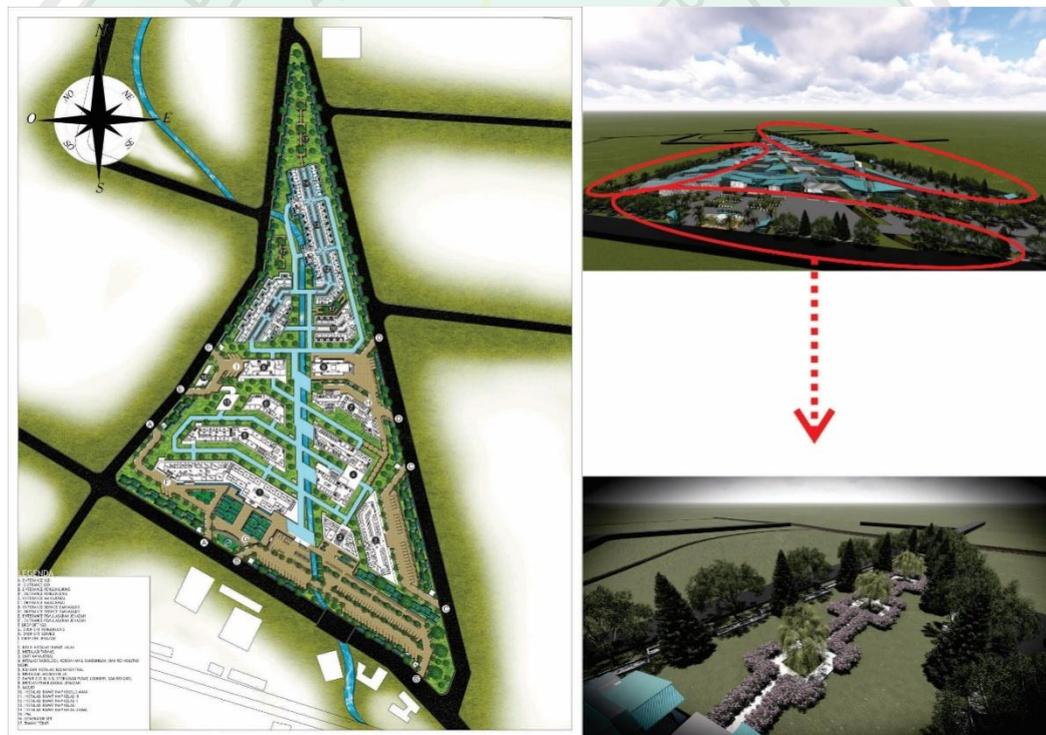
layout plan (sumber: hasil perancangan. 2015)
